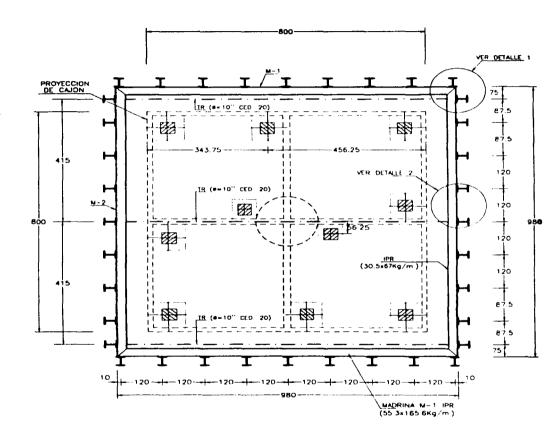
PLANTA DE EXCAVACION DEL CAJON TIPO IV
